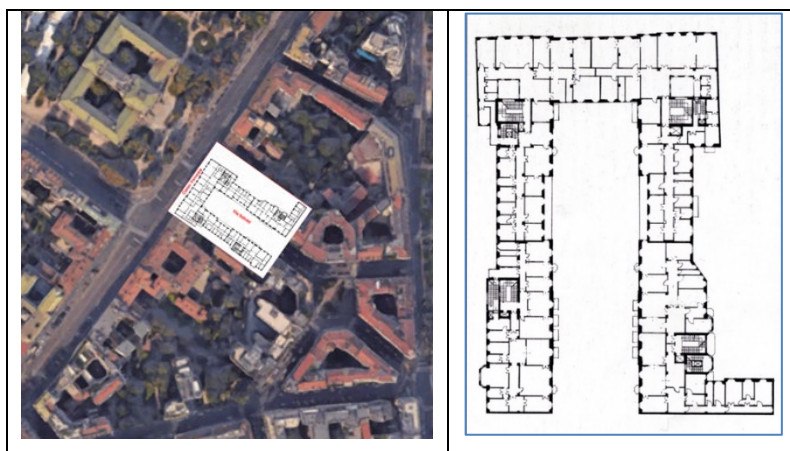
Planimetria e pianta del 5° piano (Archivio Portaluppi)
